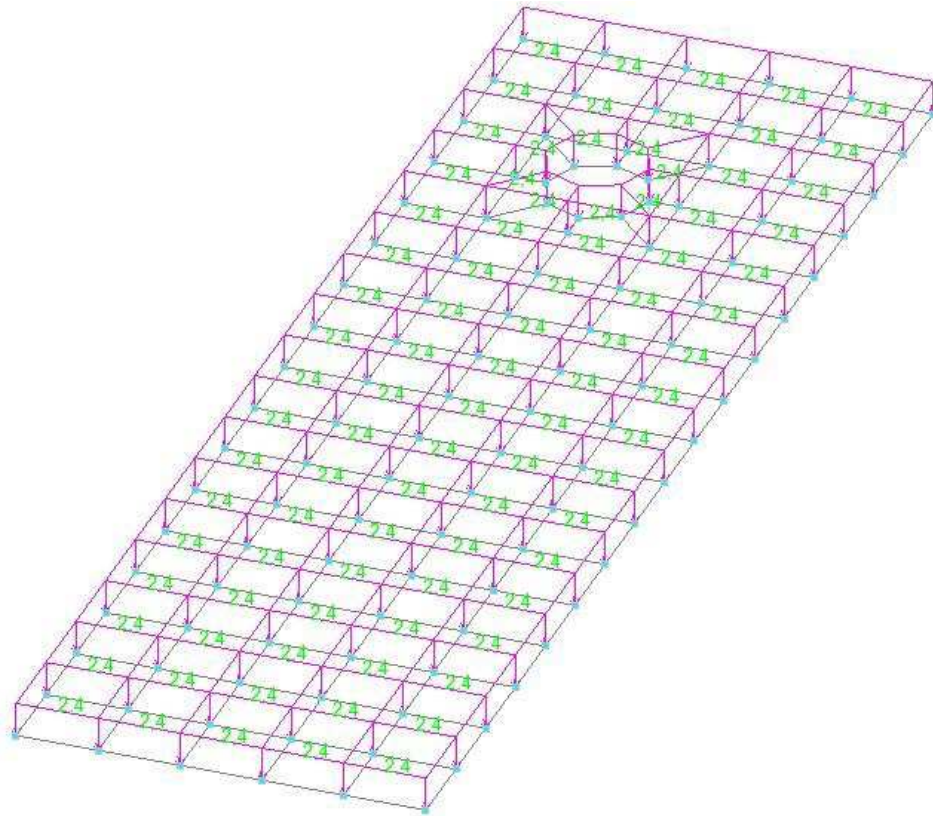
Схема загрузки плиты нагрузкой от собственного веса
